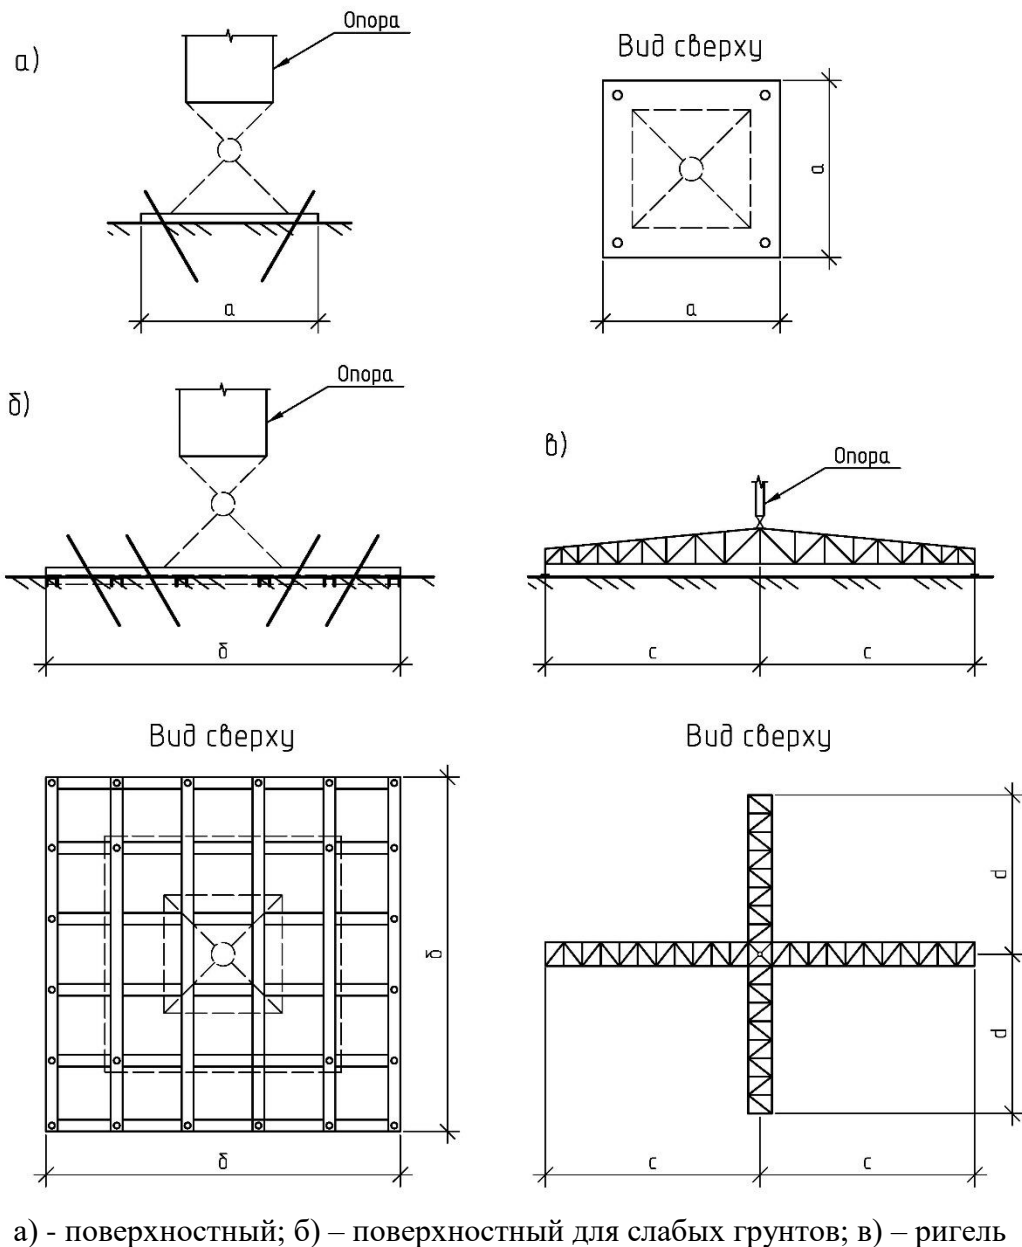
Примеры фундаментных конструкций для оттяжек БМО
